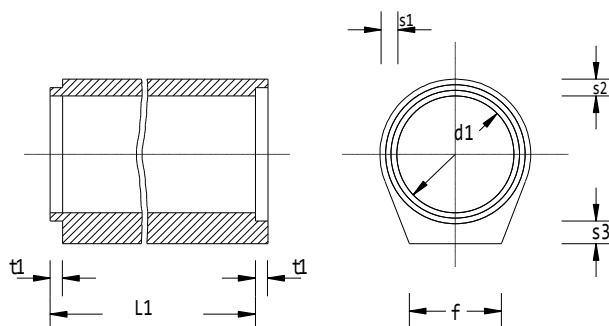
tubi in calcestruzzo di sezione circolare con giunto a risega e piede
